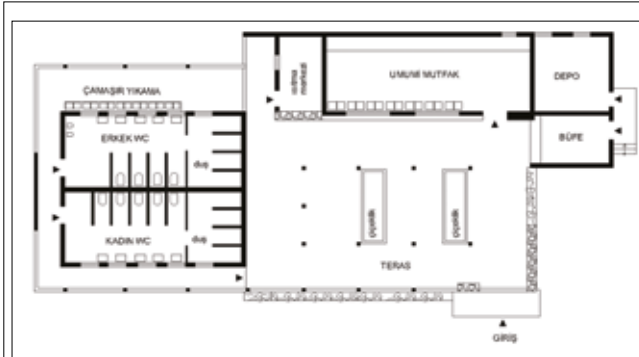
1966 yılı veya öncesi değişen zemin kat planı / Ground floor plan changed in 1966 or earlier
